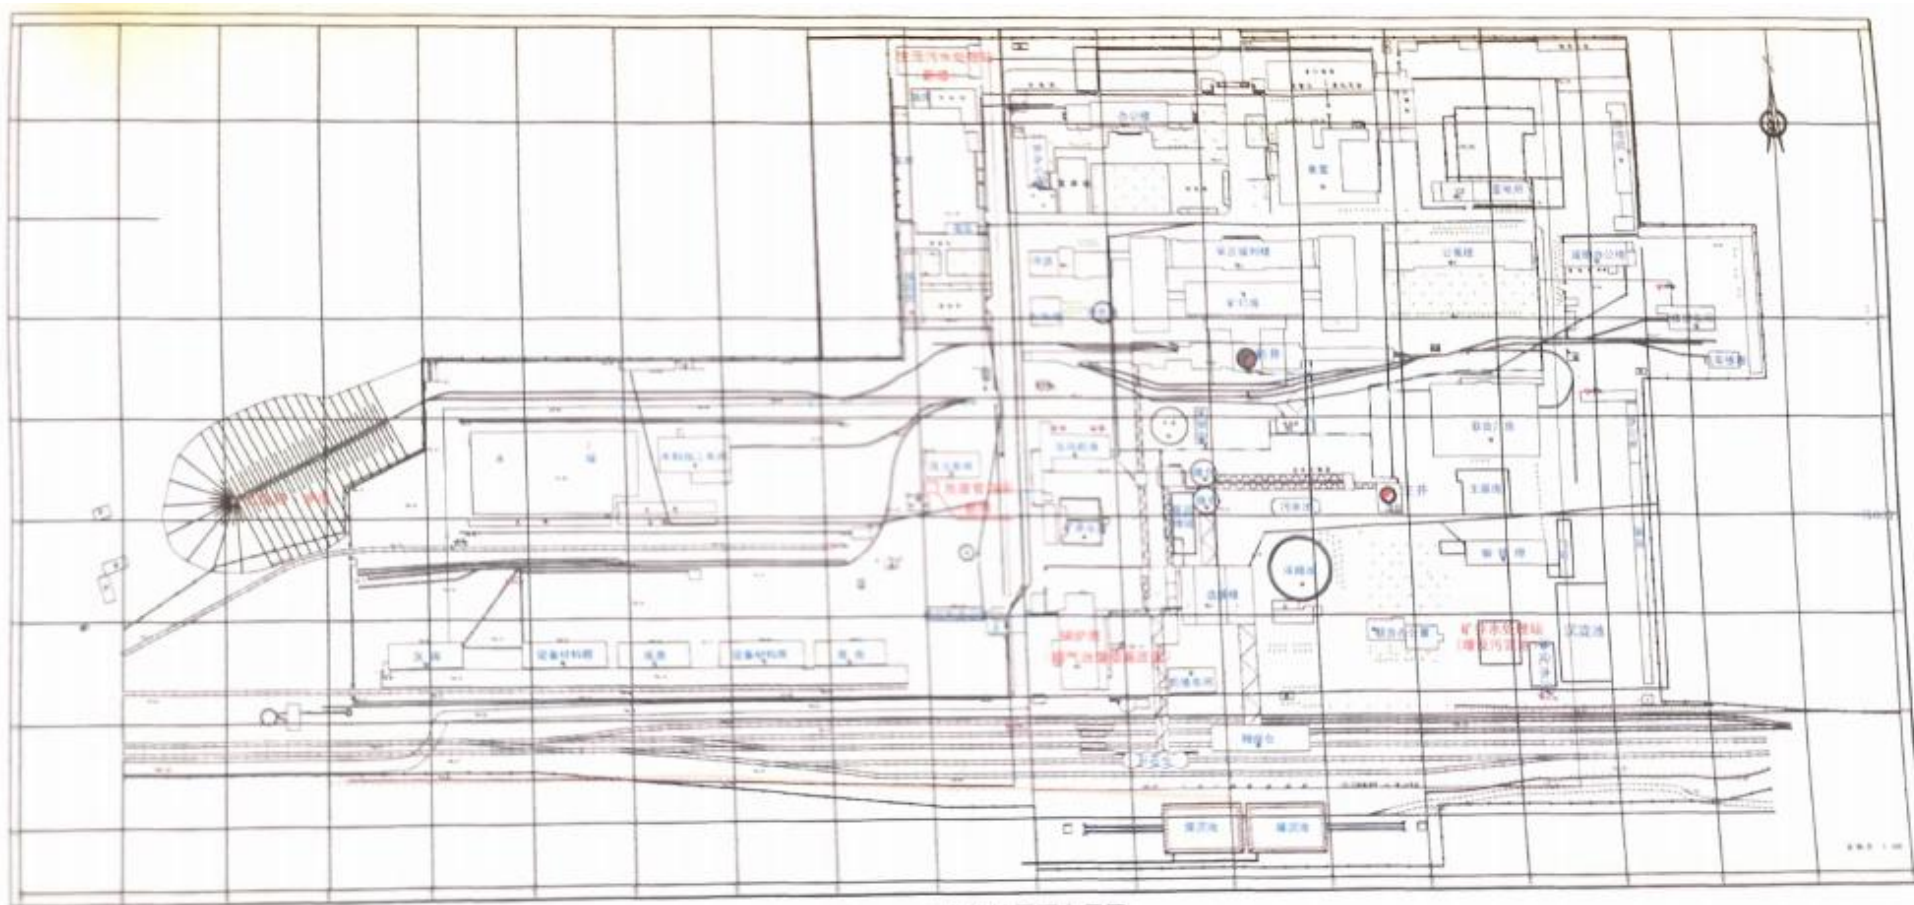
现状评估恒大煤矿工业广场平面布置图
